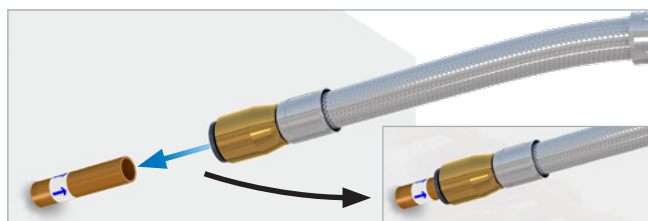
Exempel på vattenanslutning med Push-On flexibel slang.
